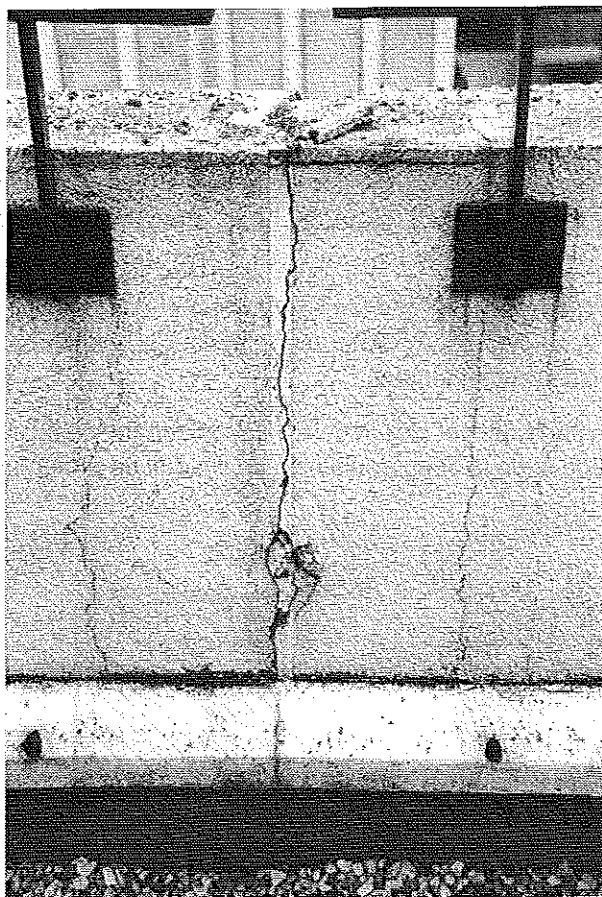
Défaut de couronnement d'acrotère ; fissuration et décollement de l'enduit. © J. Putatti
